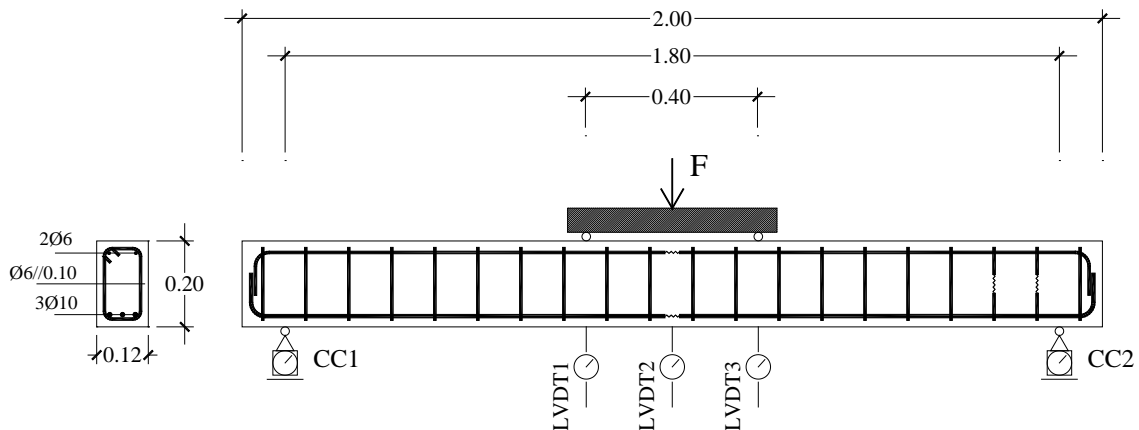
Esquema de carregamento e instrumentação das vigas em betão armado.
